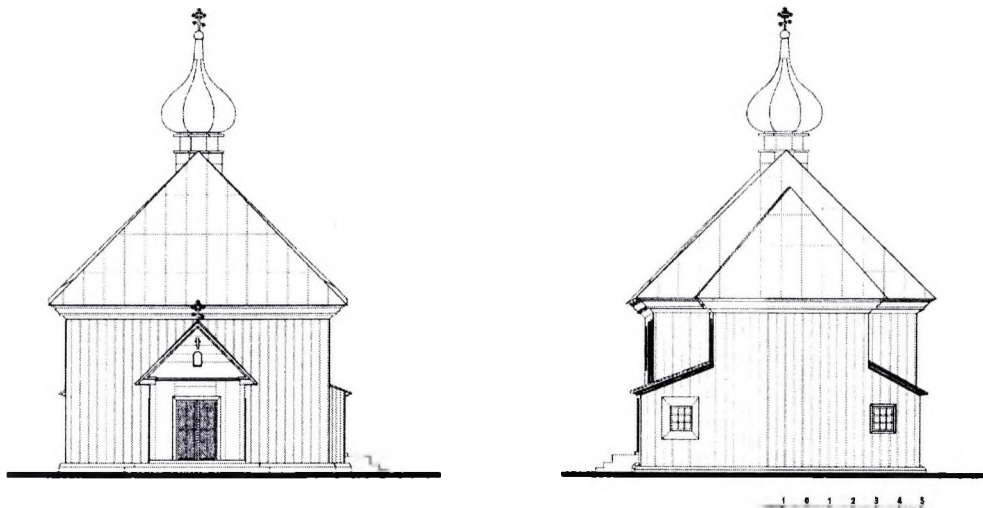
Главный фасад и фасад со стороны апсиды
